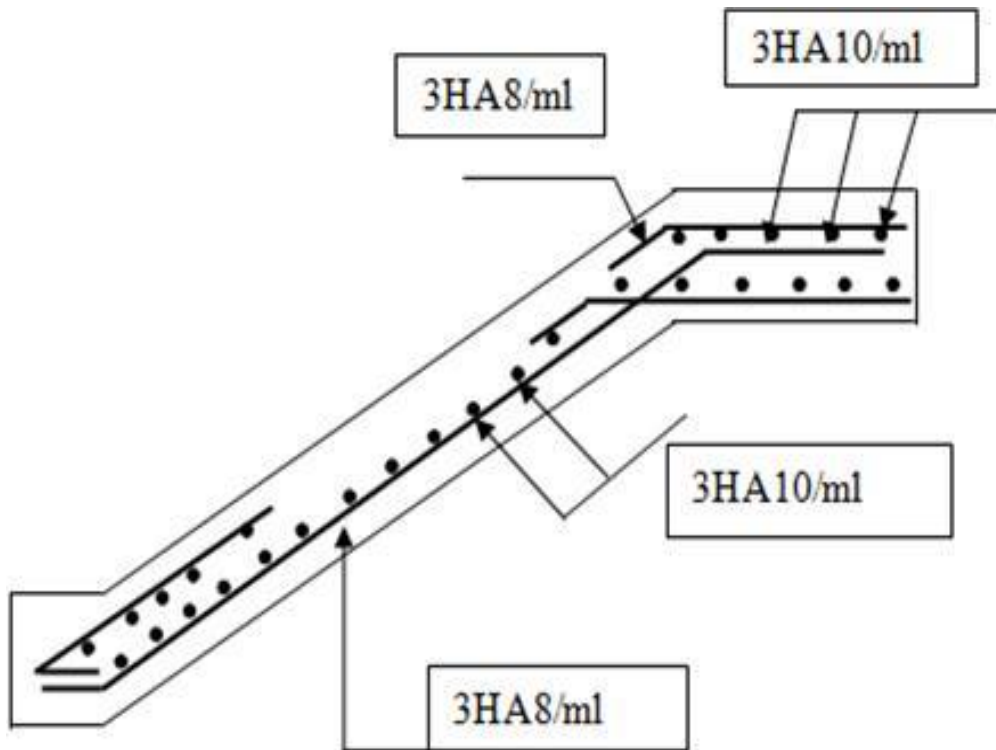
Schéma de Ferrailage de l'escalier.
